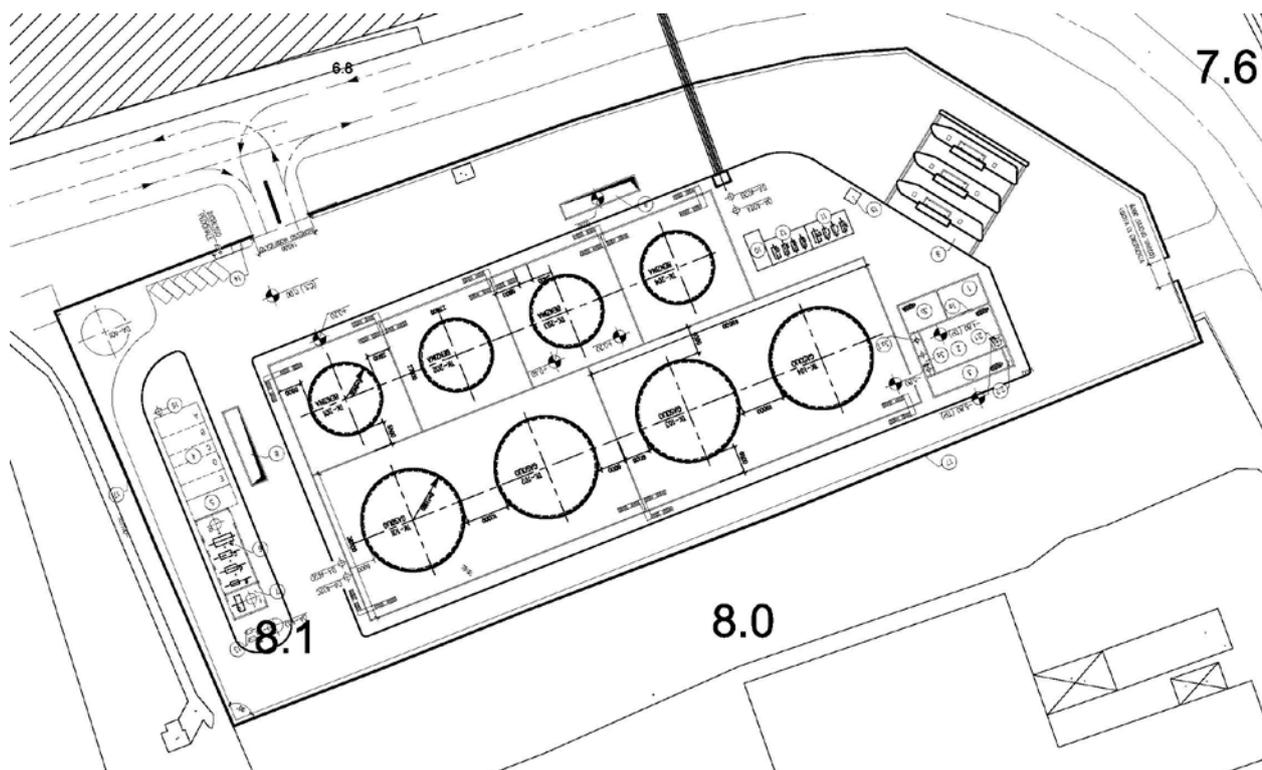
LAYOUT DI PROGETTO DEL DEPOSITO COSTIERO
